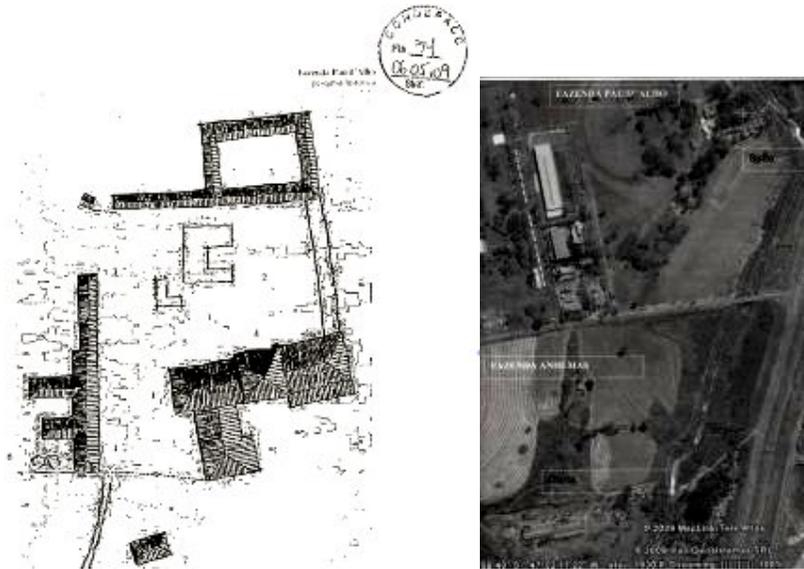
Planta de reconstituição hipotética do conjunto arquitetônico (sem escala)
